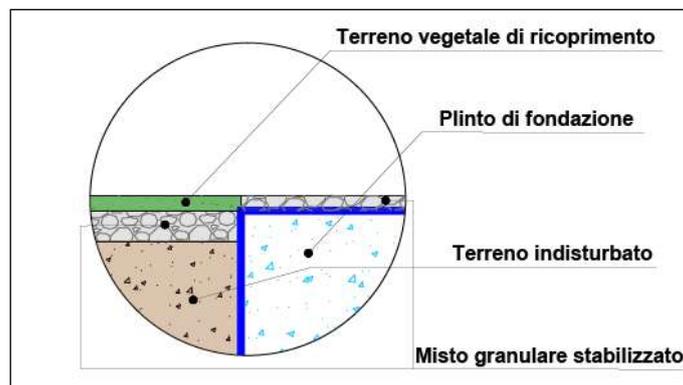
Particolare pavimentazione piazzola tipo in fase di esercizio
